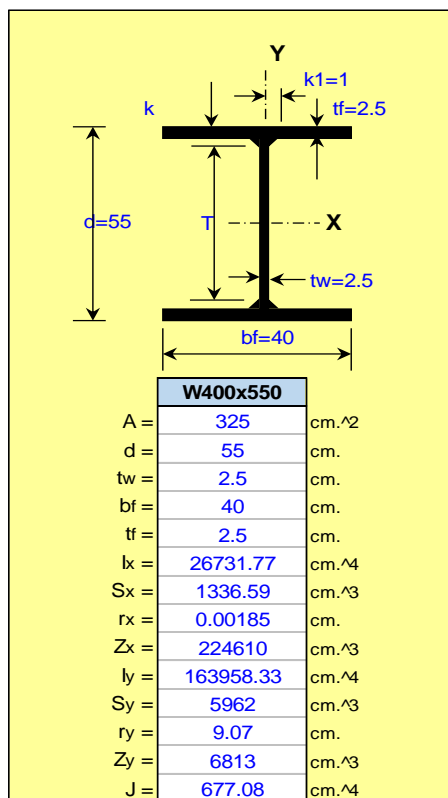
Propiedades del perfil de la Columna "C2" - Sistema estructural mixto.
